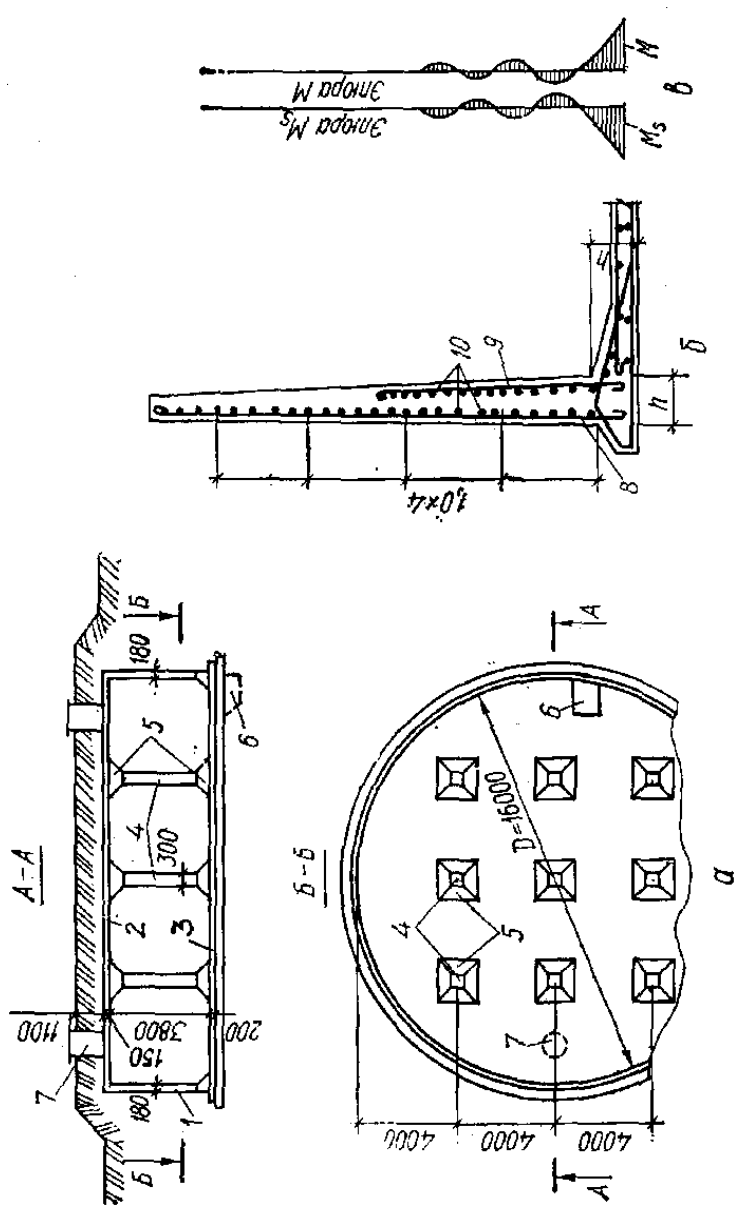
Циліндричний монолітний резервуар з балковим покриттям: *a* – конструкція резервуару; *б* – армування стінки; *в* – епюри згинальних моментів в стінці від тиску ґрунту і рідини; 1 – стінка; 2 – армування плита покриття; 3 – плита дна; 4 – колони; 5 – капітелі; 6 – приямок; 7 – люк; 8 – вертикальна армуатура за розрахунком на момент від тиску ґрунту; 9 – те ж, при врахуванні тиску рідини; 10 – кільцева армуатура з розрахунку на дію розтягнуто чого зусилля
